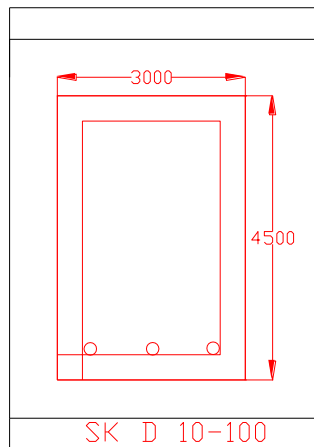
Detail penulangan Balok Tumpuan Srpm
